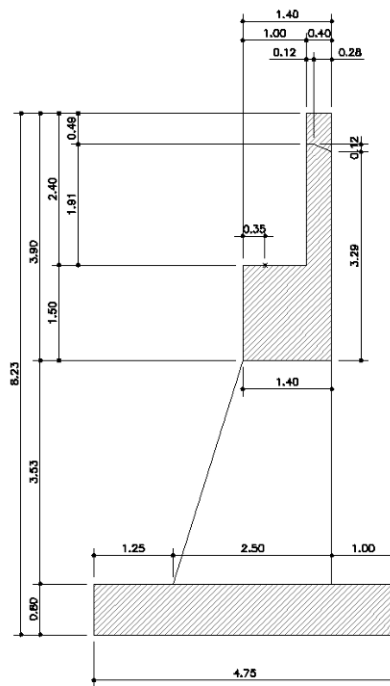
Geometria di calcolo spalla esistente
